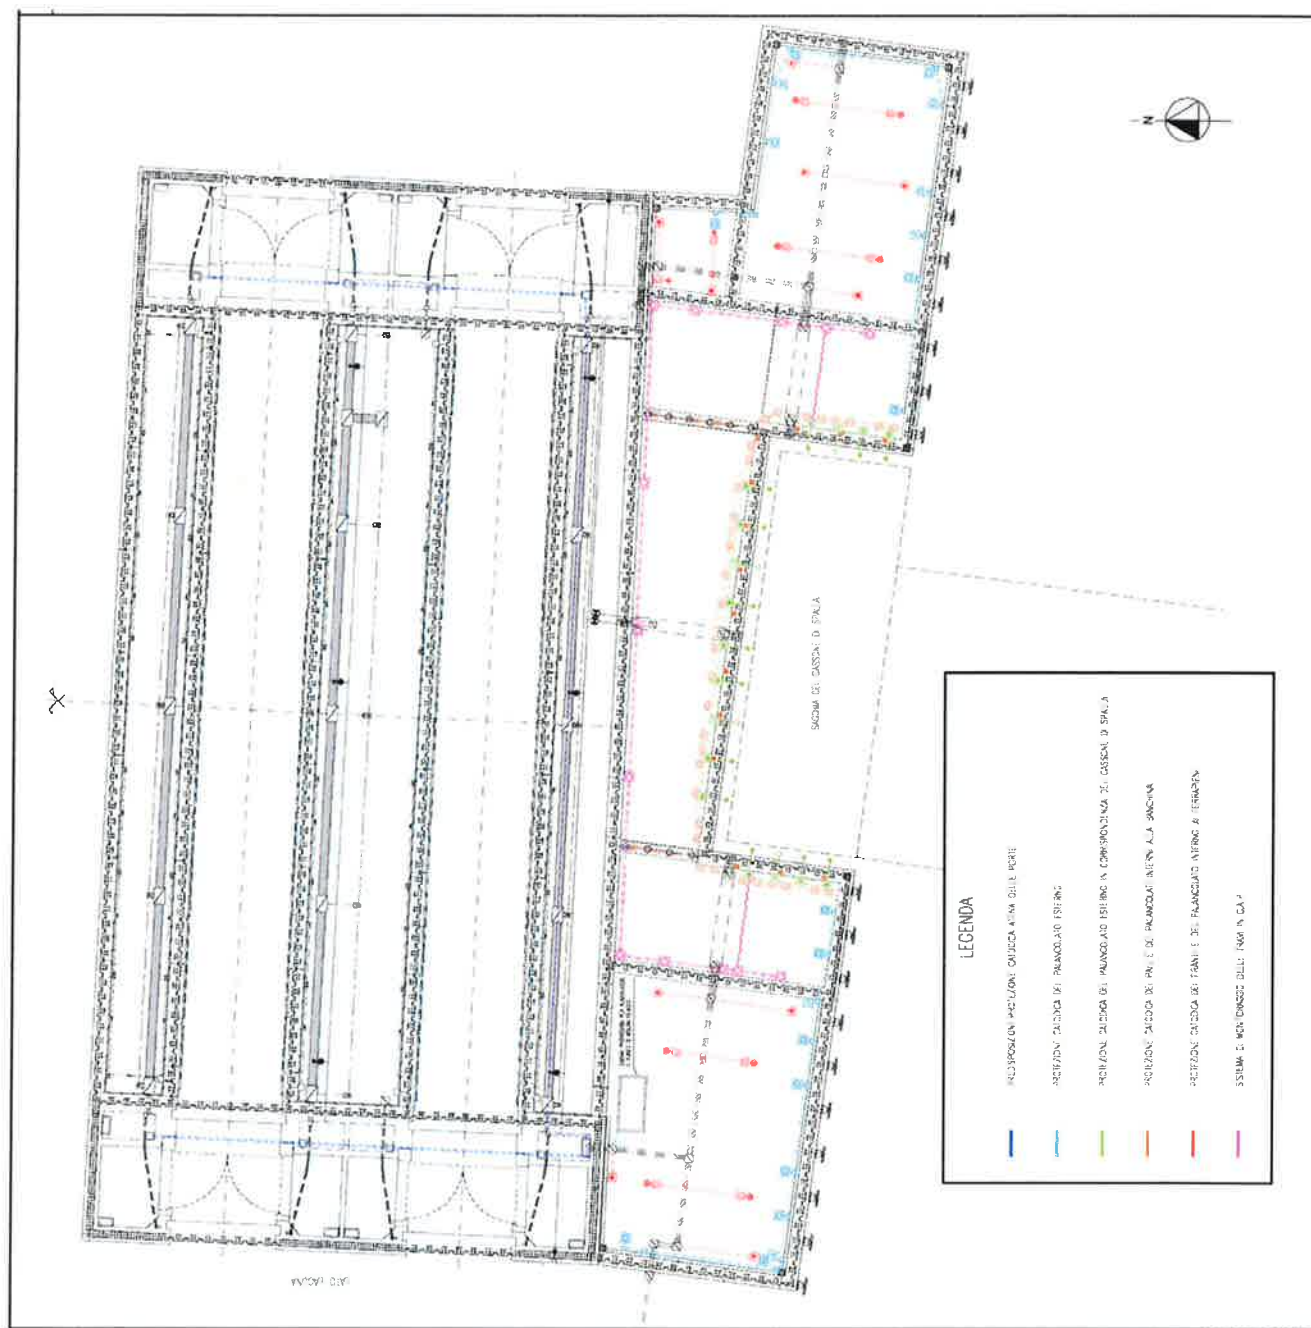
PLANIMETRIA DELLE OPERE - PREDISPOSIZIONI PER LA PROTEZIONE CATODICA
